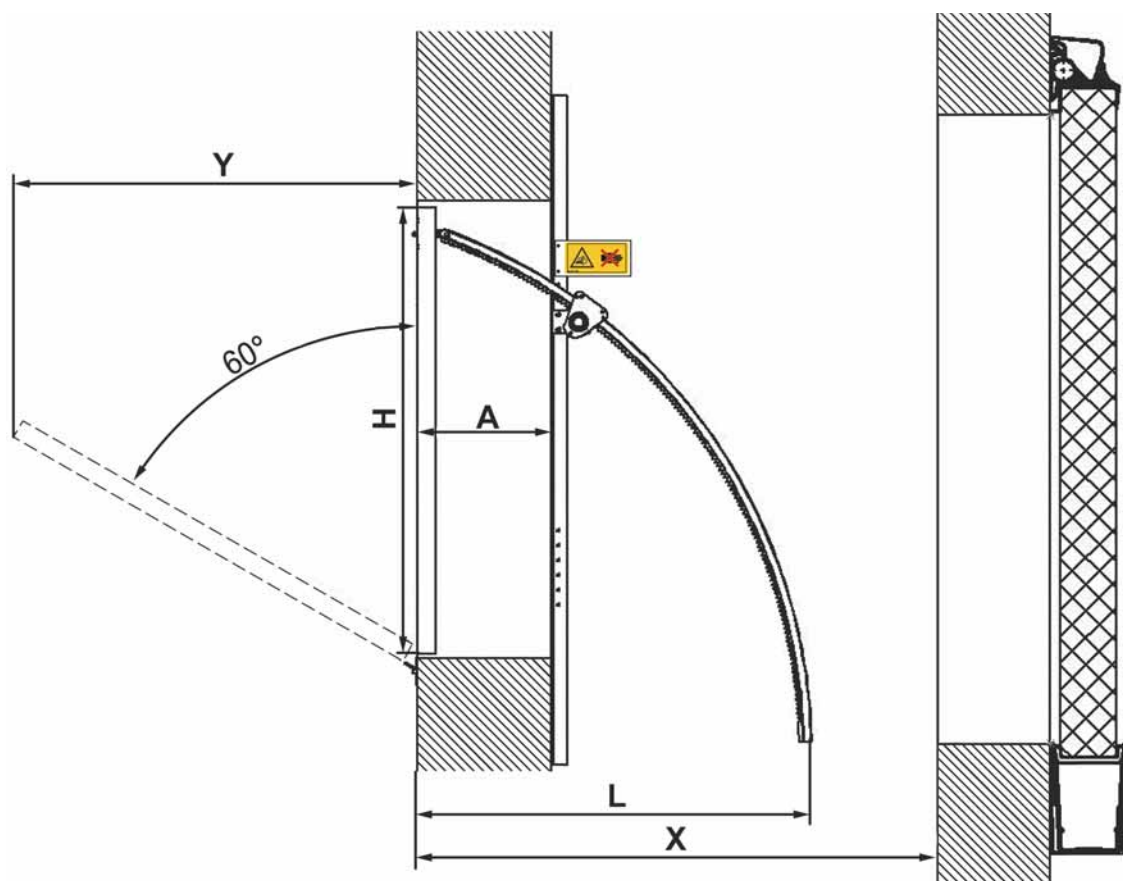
纵向进风板尺寸 (60° = 最大开启量)
